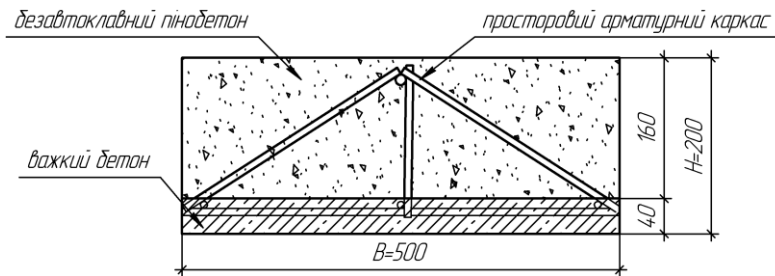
Поперечний переріз збірно-монолітних залізобетонних плит перекриття із використанням безавтоклавного пінобетону
